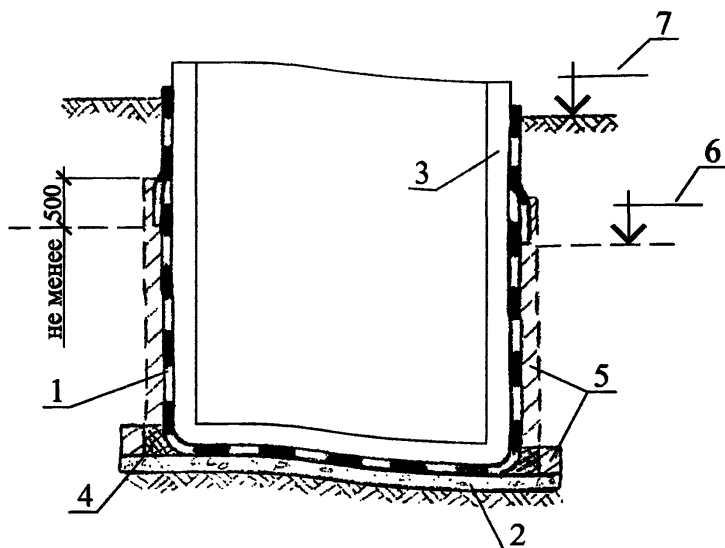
Гидроизоляция заглубленных сооружений от напора грунтовых вод
